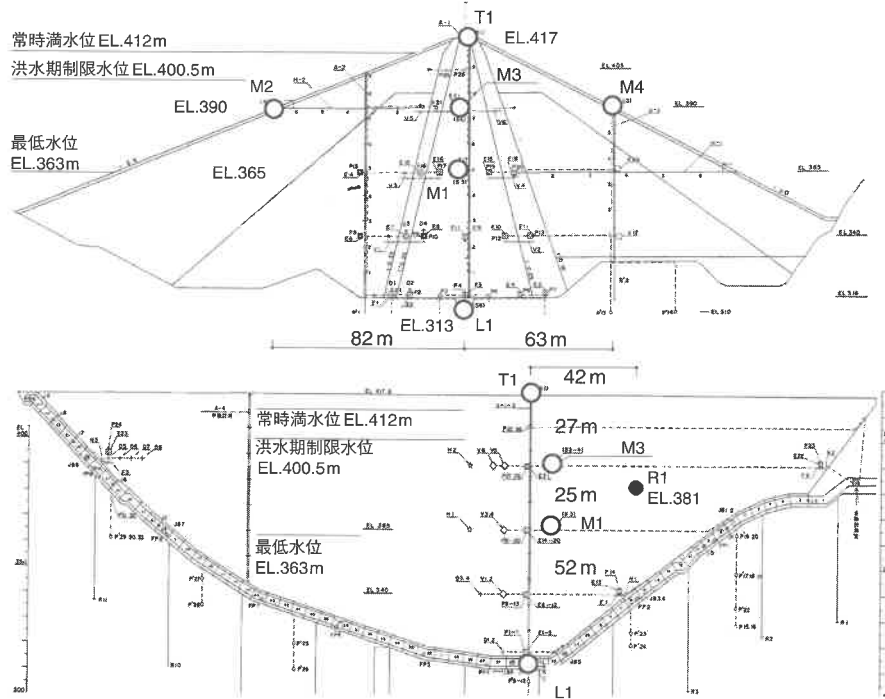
阿木川ダムの標準断面図と縦断面図¹³⁾
